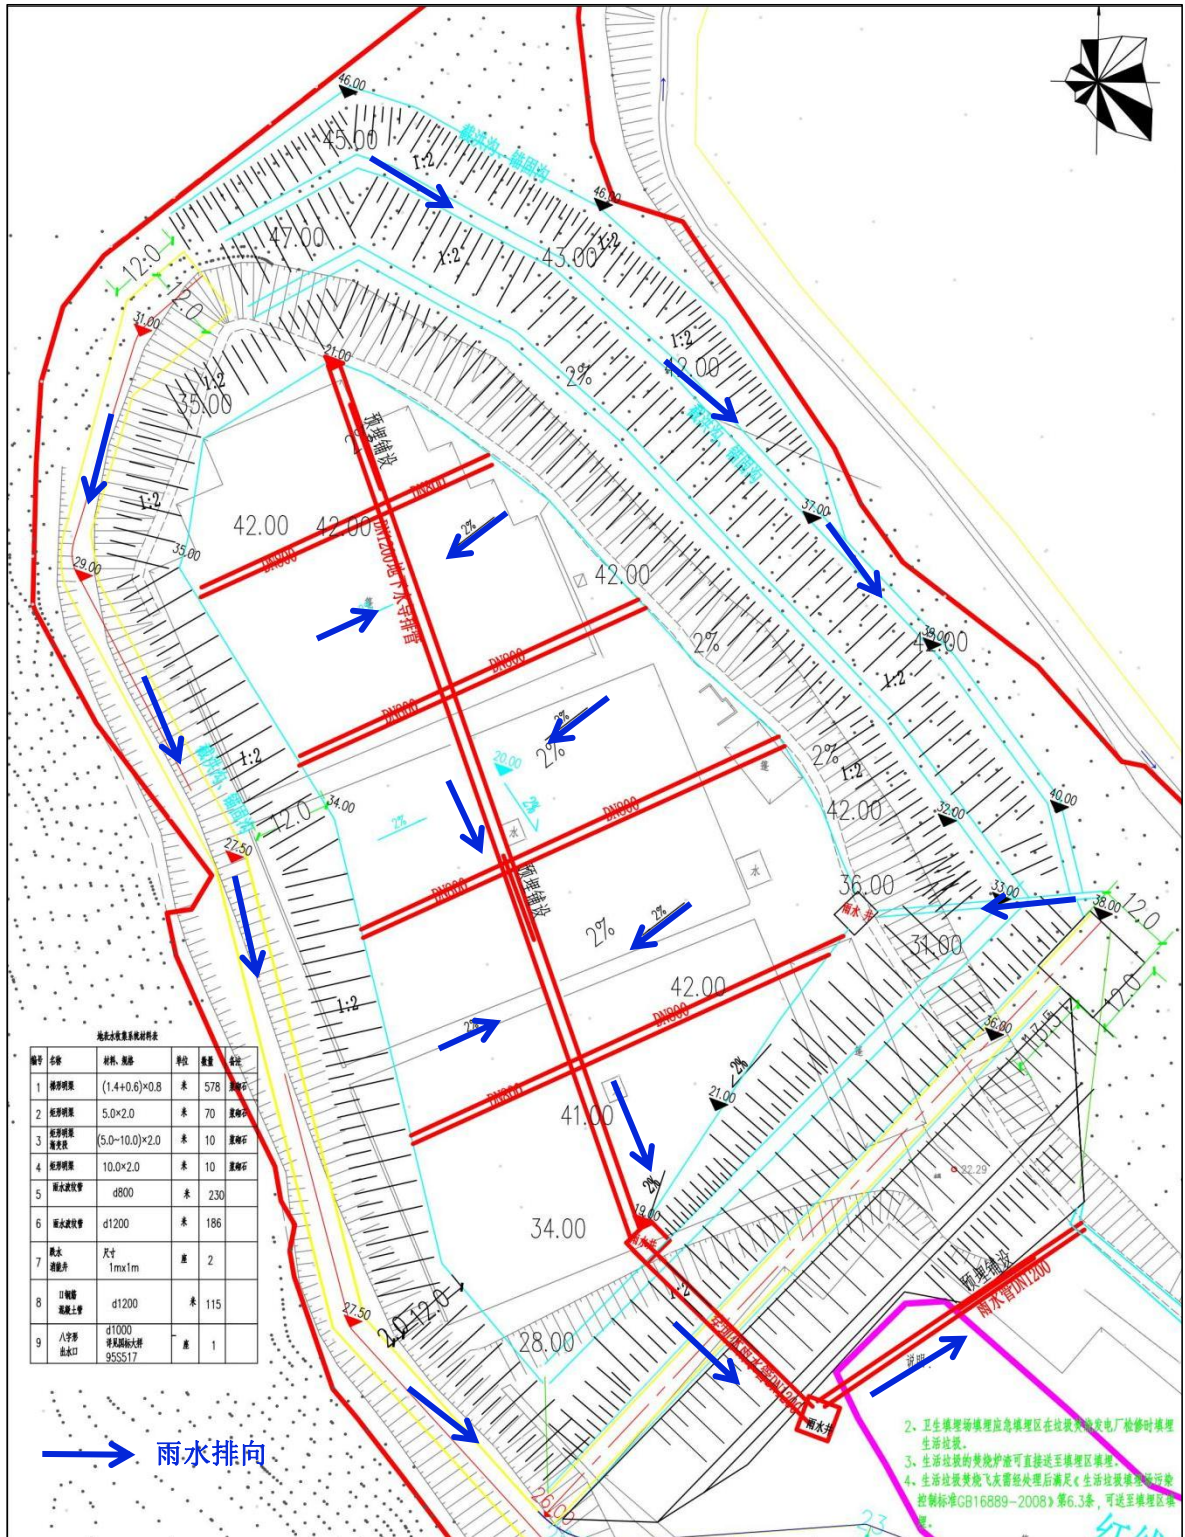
飞灰填埋场雨水排水沟平面布置图
